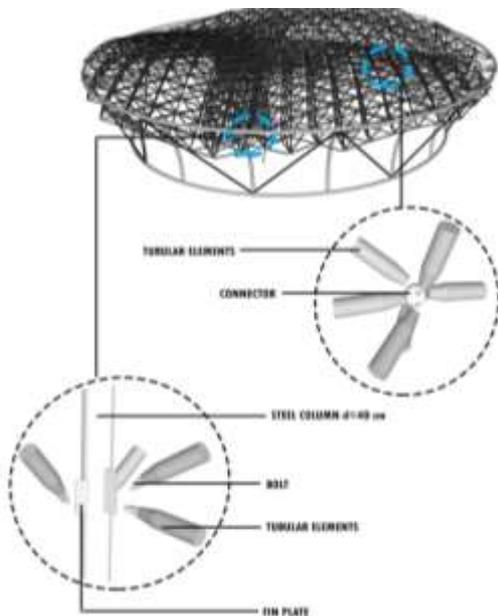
18. Detail Struktur Pada Kolom Melengkung Bangunan Utama
